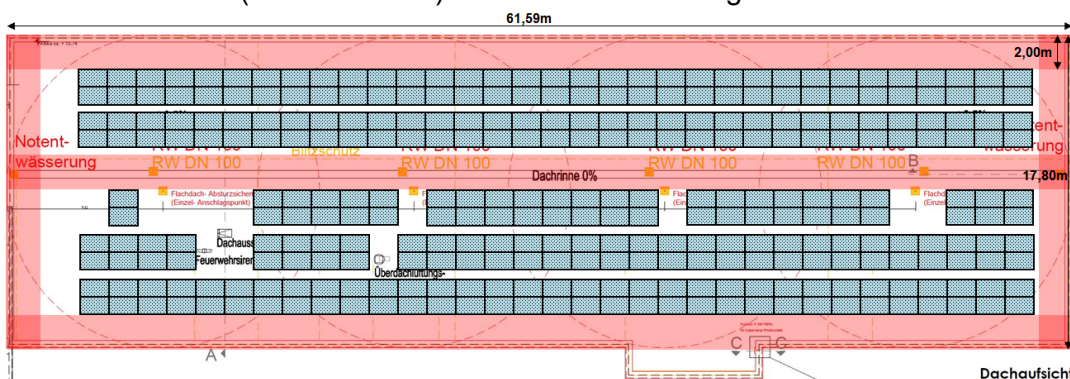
, Dachaufsicht mit Anordnung der Solarmodule
